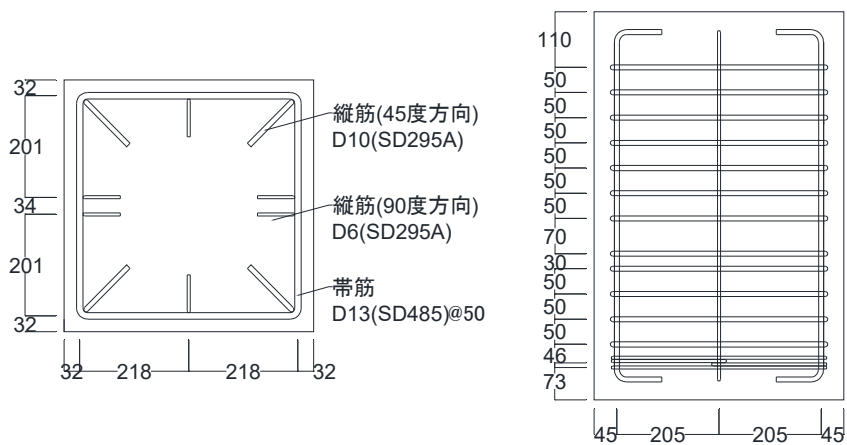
試験体 D-4 パイルキャップ断面詳細図
